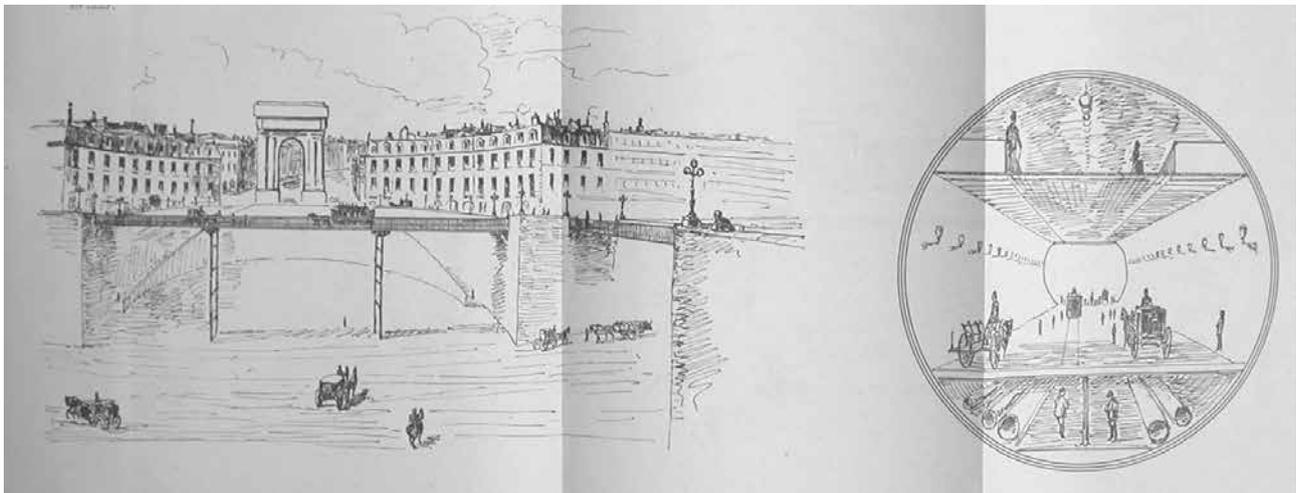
Vue du débouché du tunnel sous la porte de Bourgogne, et coupe du conduit, 1885 (A.M.Bx., 132 O 3).
